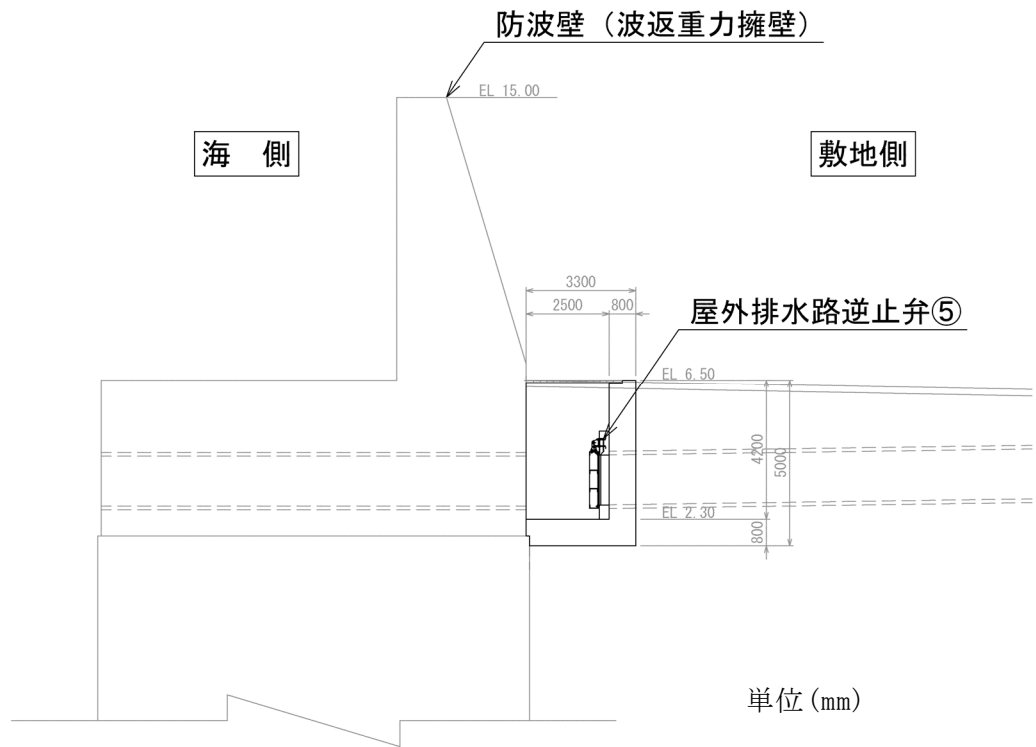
(2) 屋外排水路逆止弁⑤断面图
